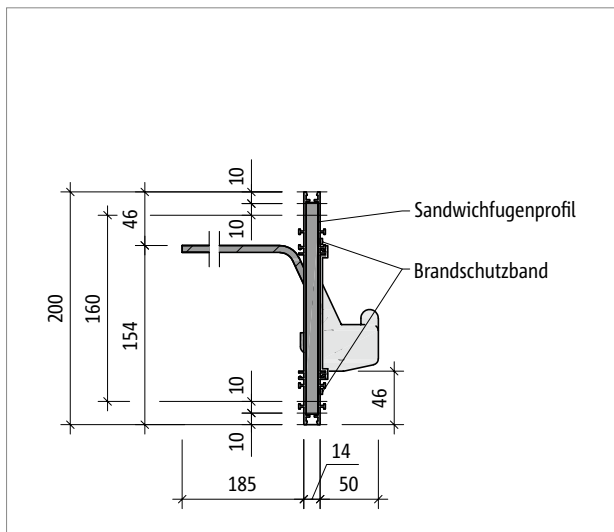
Tronsole® T: Produktschnitt mit Sandwichfugenprofil in der Grundversion
